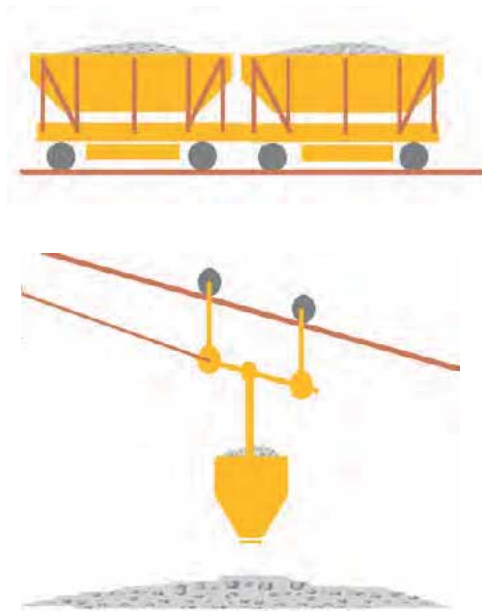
Vagonetas y cable para el transporte de concreto †
